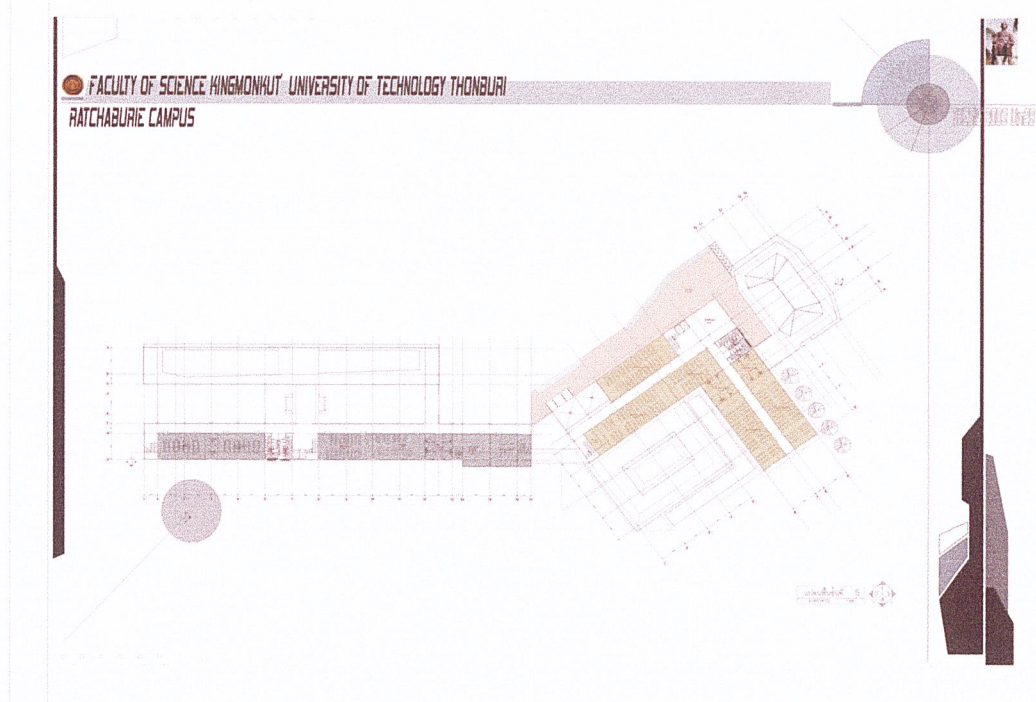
แสดง chart 2 nd floor plan
